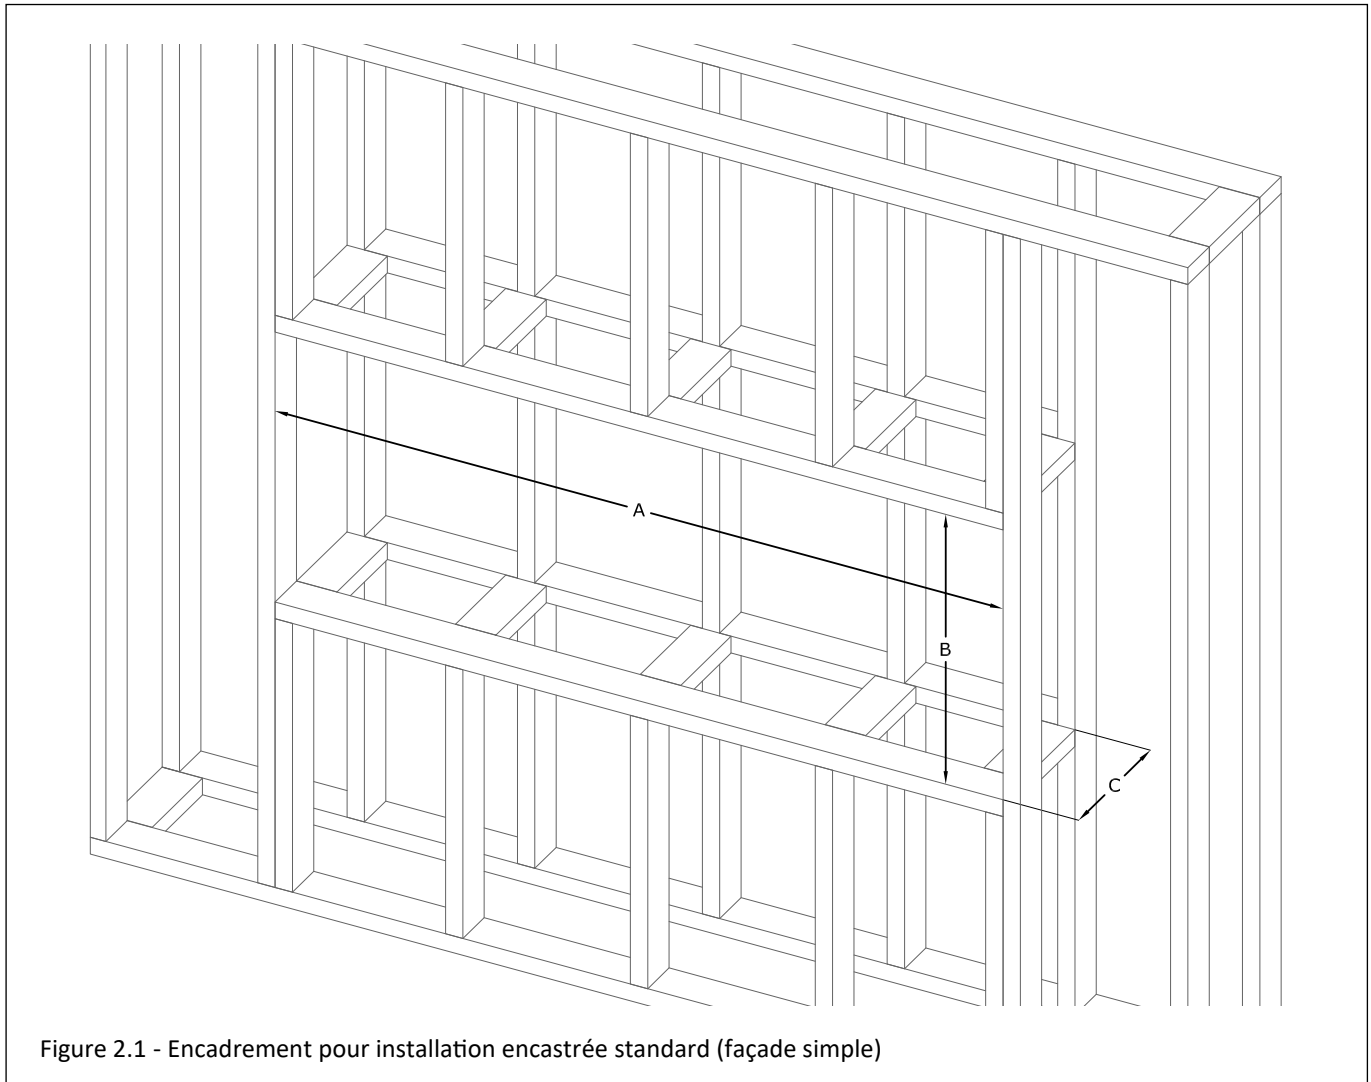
Encadrement pour installation encastrée standard (façade simple)
